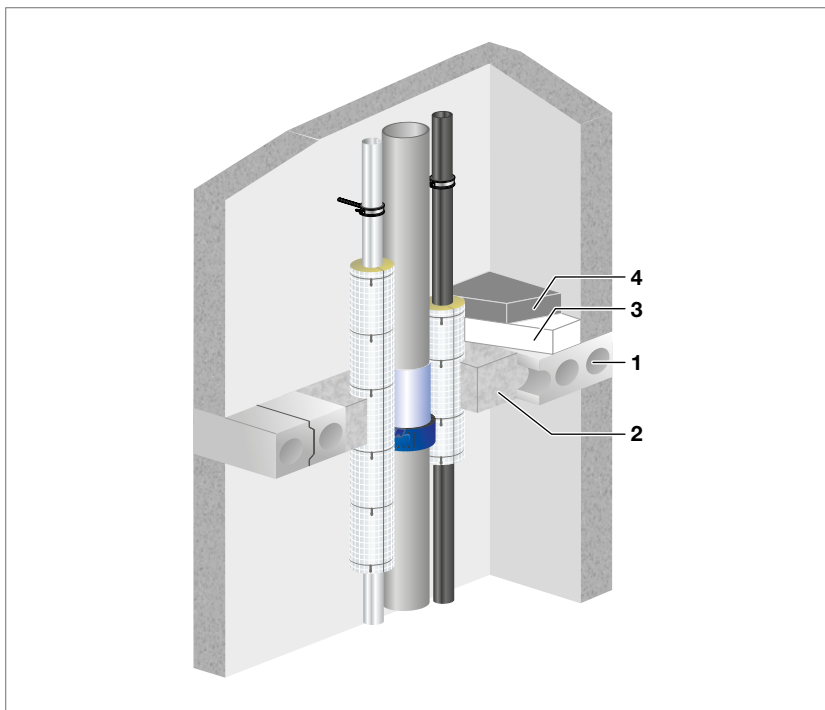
Stahlbeton- und Spannbetonplatten aus Normalbeton mit Hohlräumen
